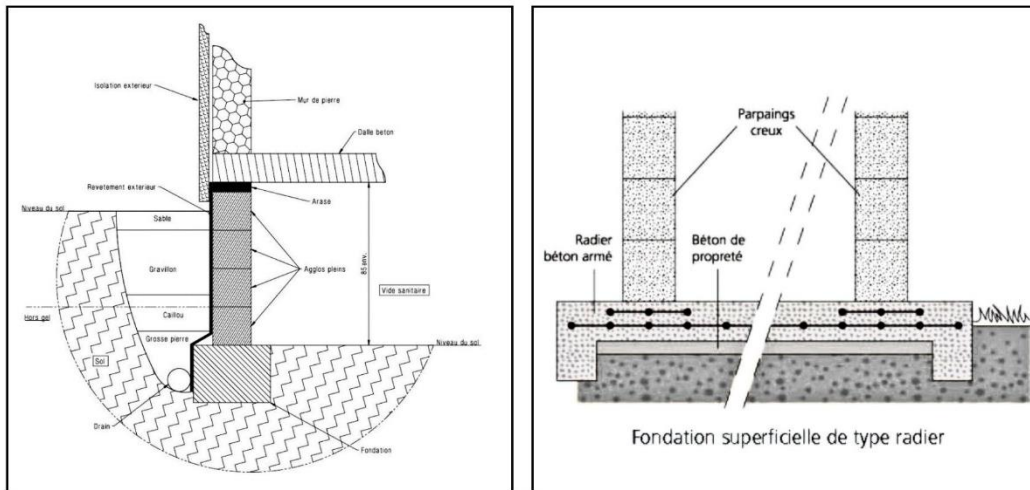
Détails techniques et coupe des fondations en dalle radier
